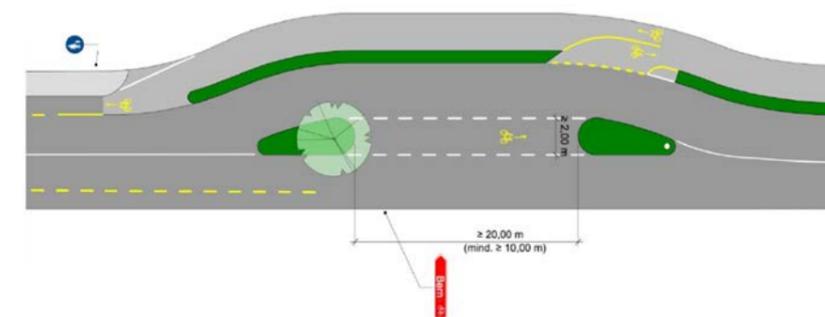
Auszug geplanter Pförtner Strassenplan Ortsdurchfahrt Biglen
